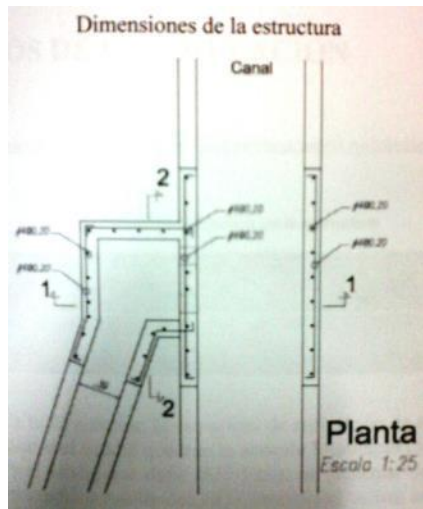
Planta de la obra de reparto a construir para la acequia La Carrilera.
